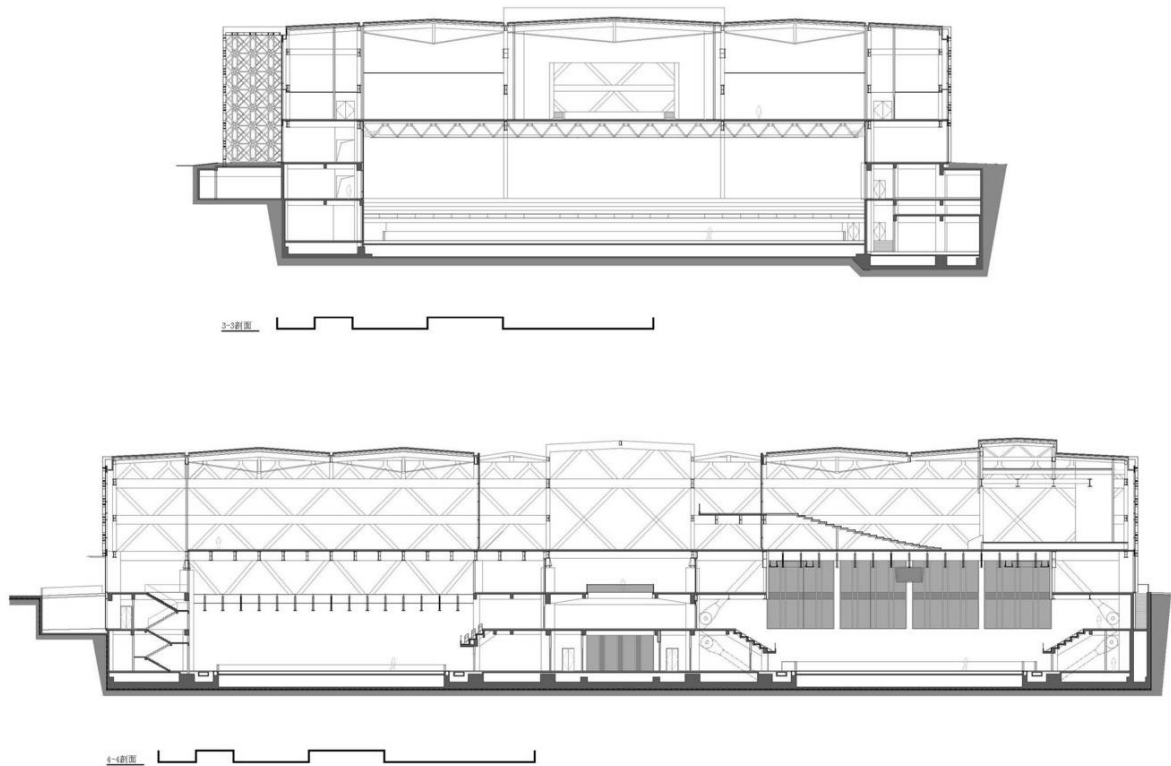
Поперечний та повздовжній розрізи, арх. BIAD-ZXD ARCHITECTS [1]
